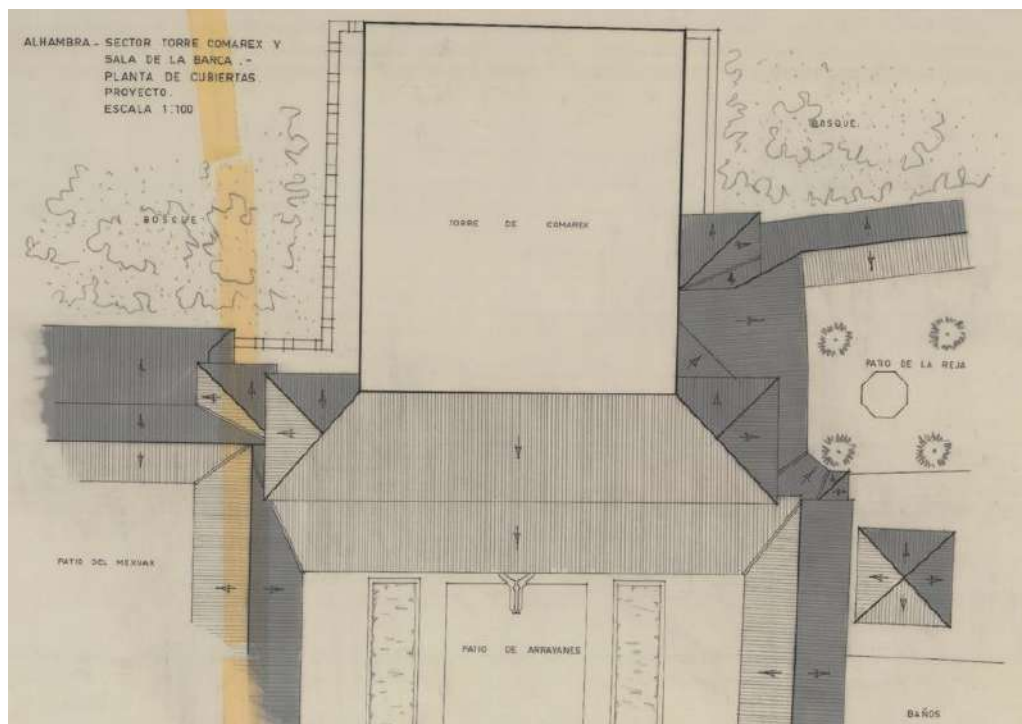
Planta de cubiertas del pórtico norte del Patio de Arrayanes. Estado propuesto. Manuel López Reche (delineante), Prieto-Moreno, 1965. (APAG/Colección de Planos/002495).
